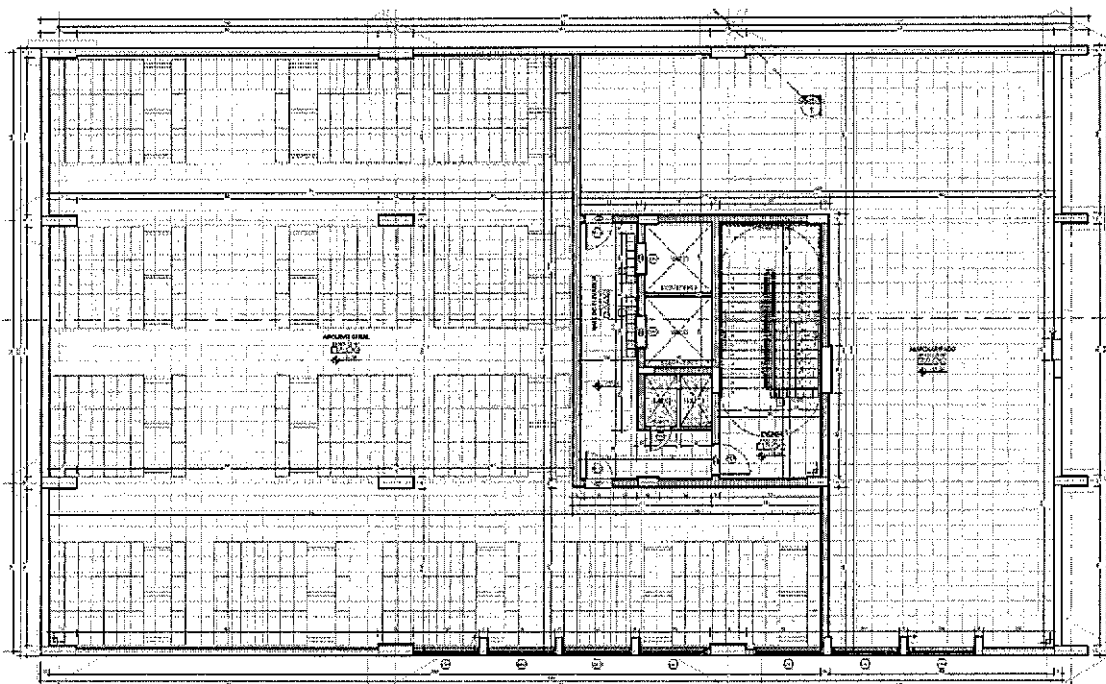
planta do subsolo da obra DRF Bauru (CAT 2620180009585), subsolo com área de arquivo e almoxarifado com 564,05m². Obra de Construção.
